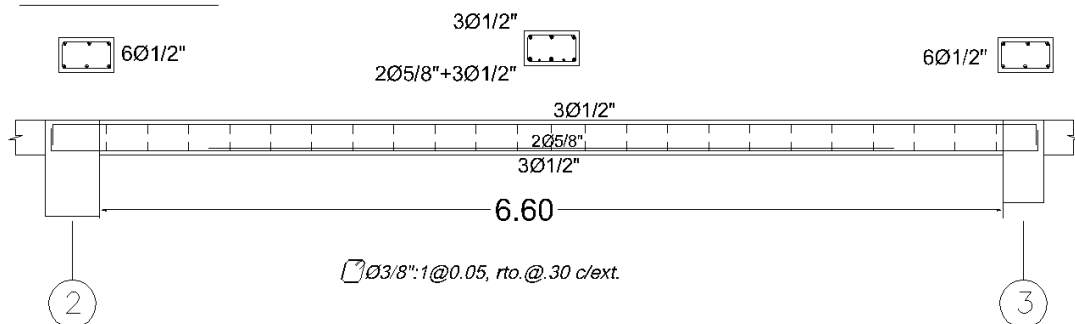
Disposición del acero colocado de la viga chata V.CHT-1
